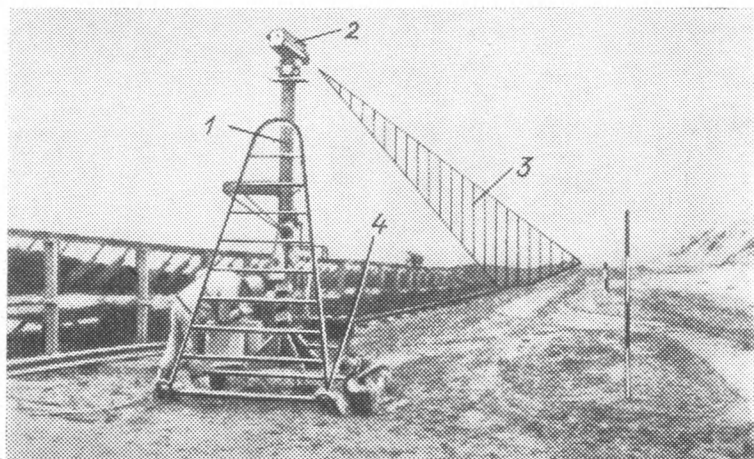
Установка лазерного прибора на салазках со штативом:
